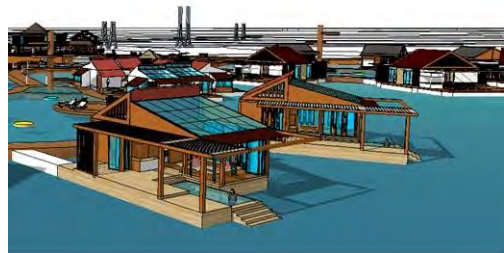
Aplikasi pada bangunan fasilitas, bangunan sewa
